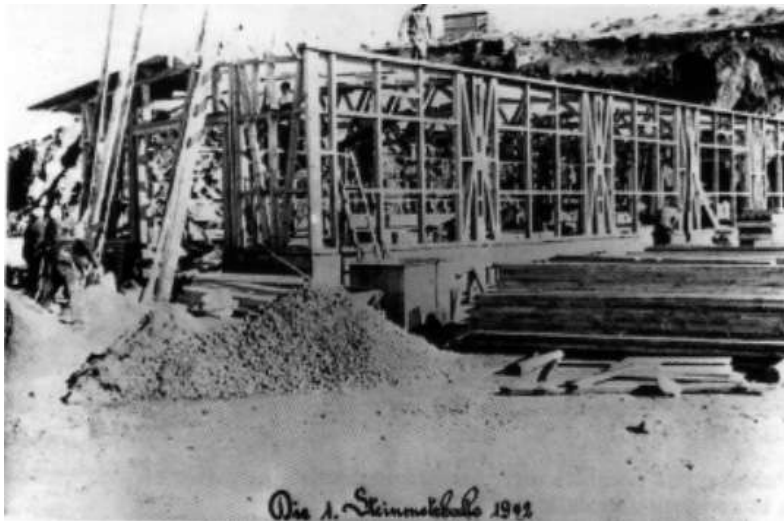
Construction de la première halle en 1942 (NATZ19_PH_ARCH_091, CERD).
